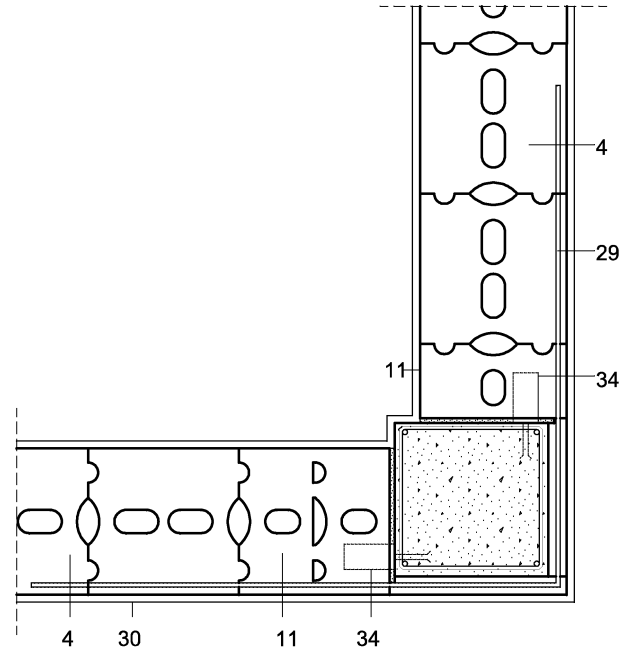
Encuentro con pilar en esquina hilada par. Muro portante. Bloque de longitud 30.
